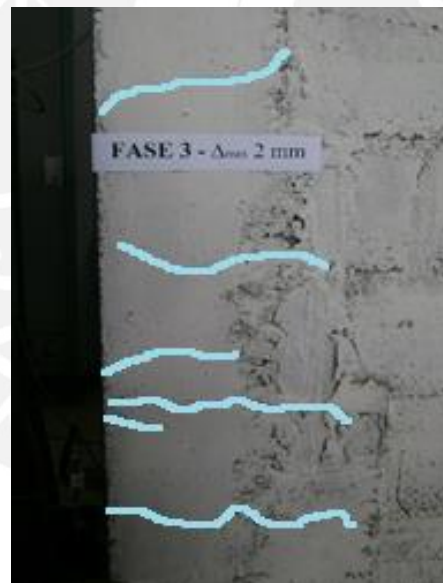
Grietas en muro: Fase 3: M1-33.
